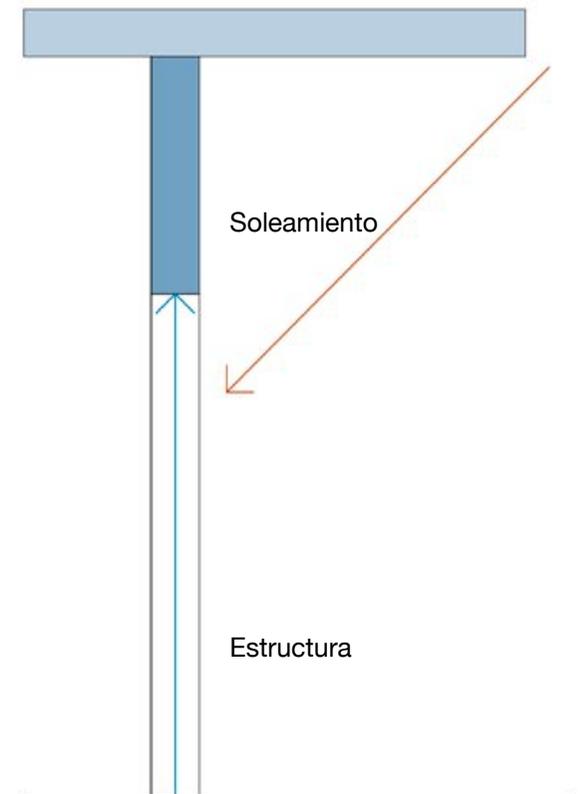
Imagen de la Sección Constructiva del colegio Paiguara.
